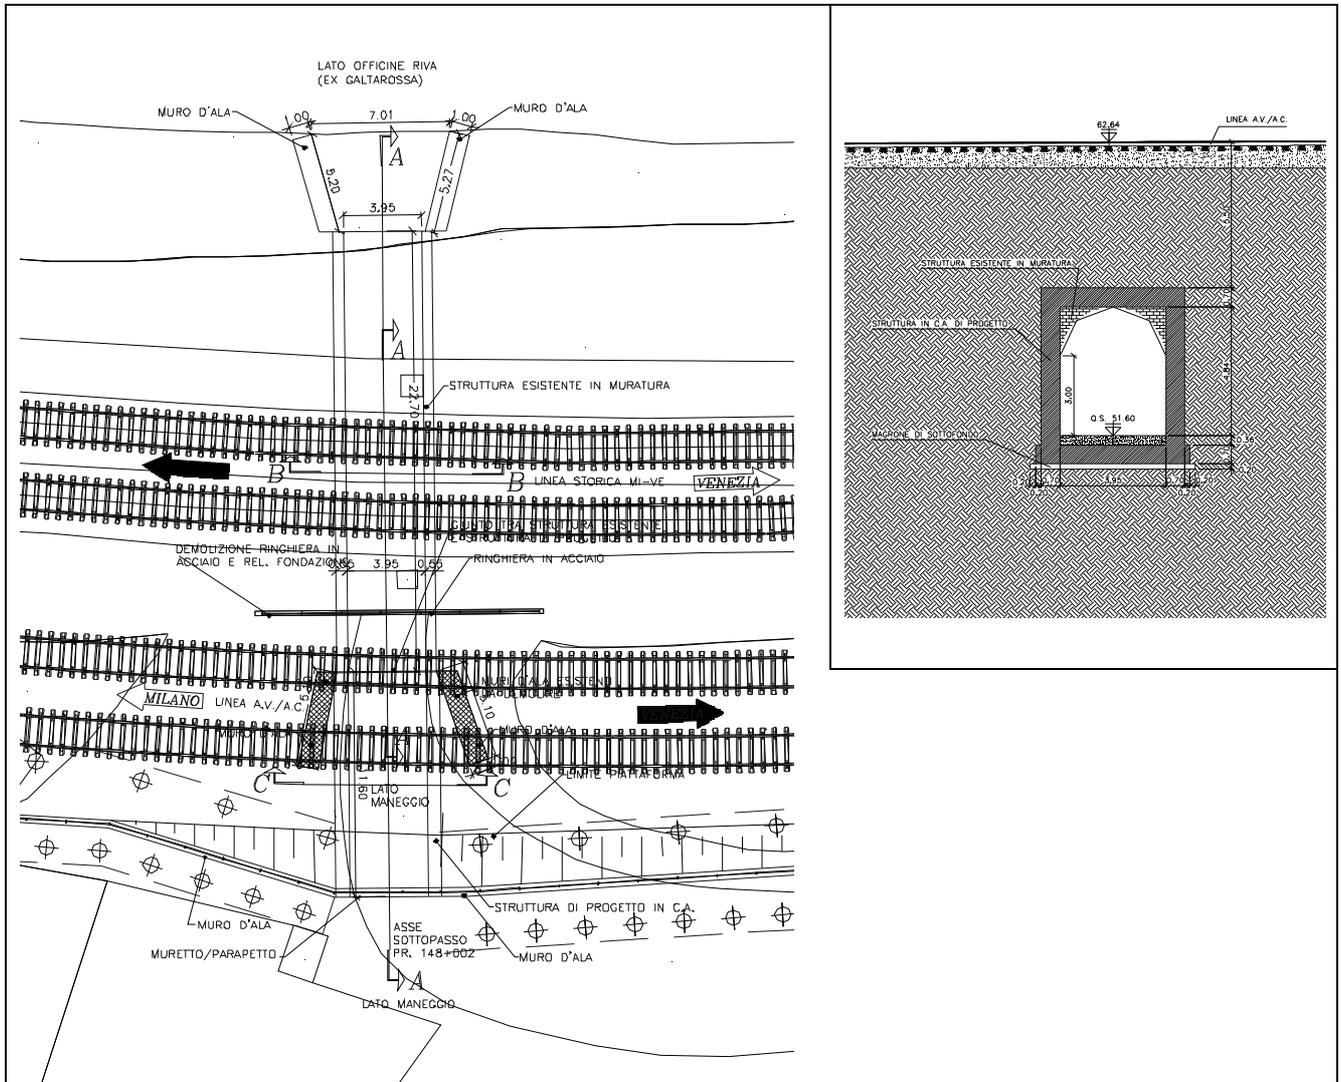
Planimetria e sezione di progetto di Galtarossa Scalo
